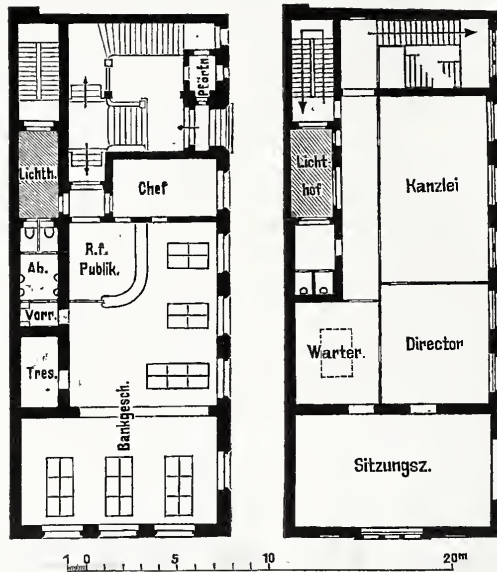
Grundriss vom Erdgeschloß.
